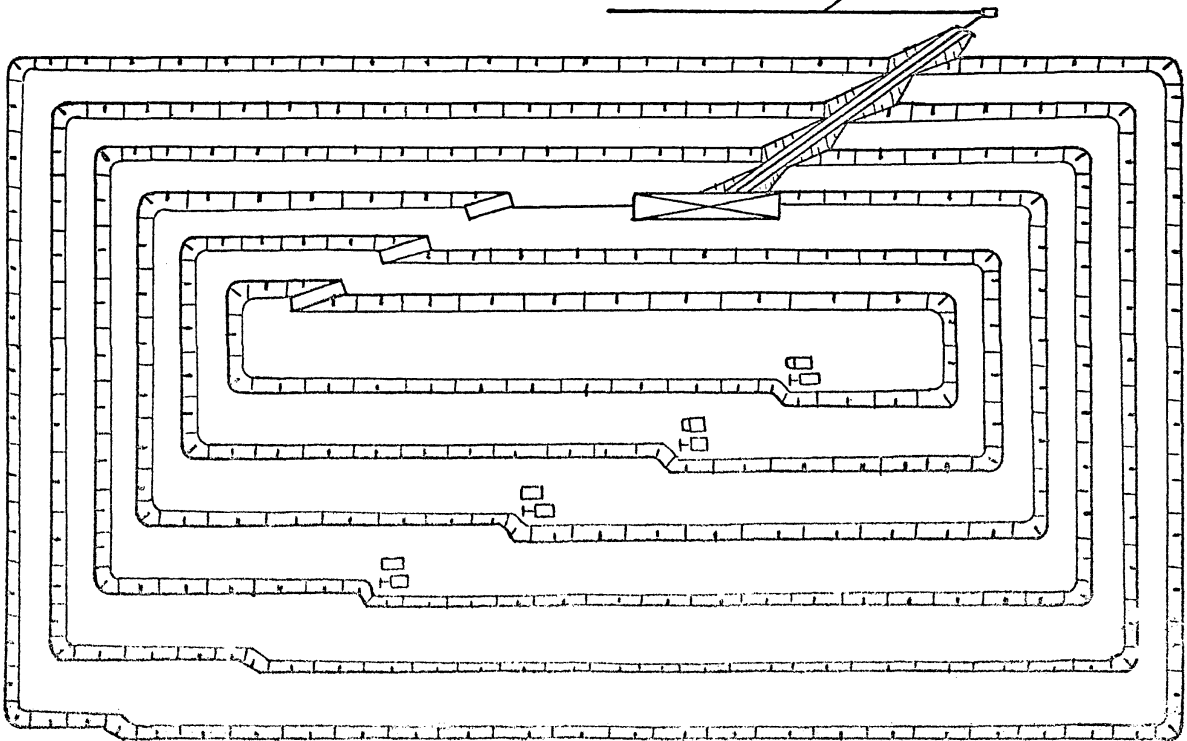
Схема прицепания конденсера поездов в качестве комбинированного внутрикарьерного агрегата и на поверхности с двумя вертикальными трубами и поочным движением по кольцевой схеме и двумя перегрузочными пунктами.
